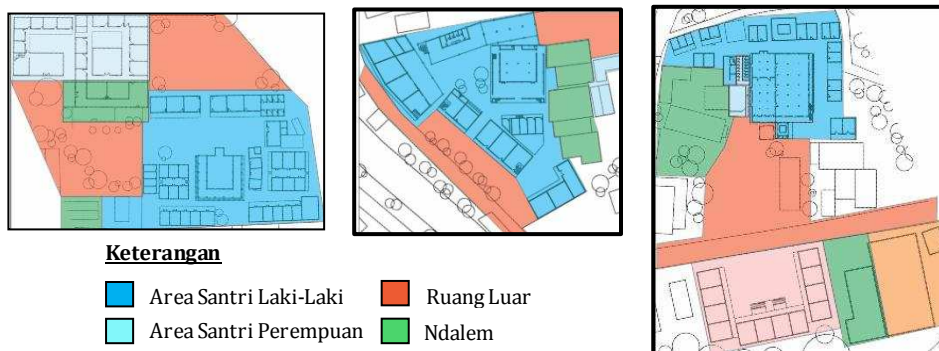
Pondok Pesantren Salaf Bahrul Ulum Sahlaniyah
